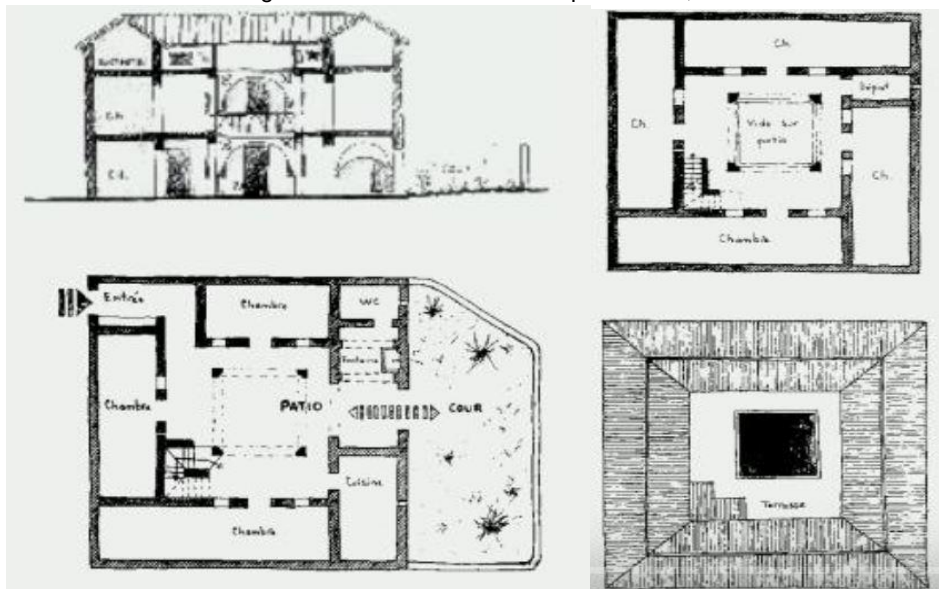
plantas y alzados Casa patio en Xuaen -Marruecos-
